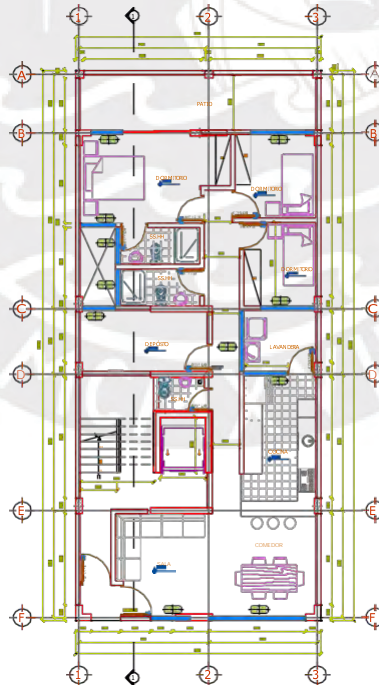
Vista en planta típico, Edificio de Muros Estructurales.
